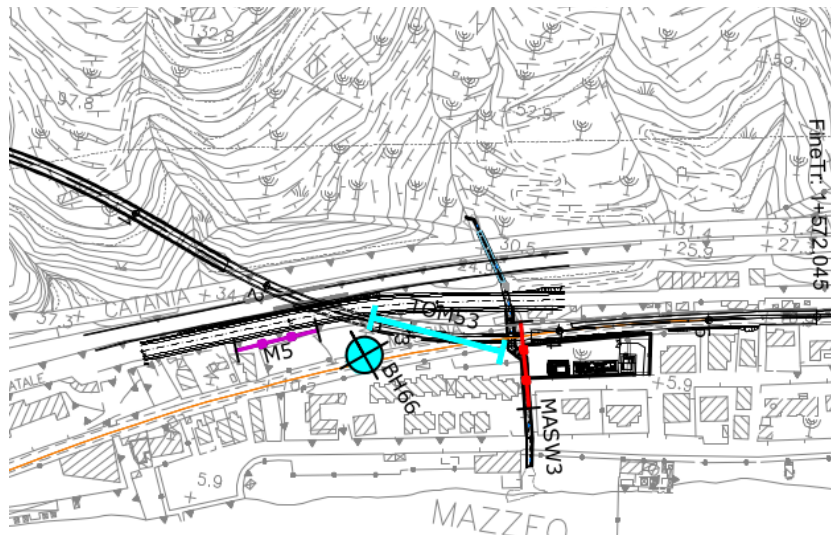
Stralcio della planimetria con ubicazione del sondaggio BH66
